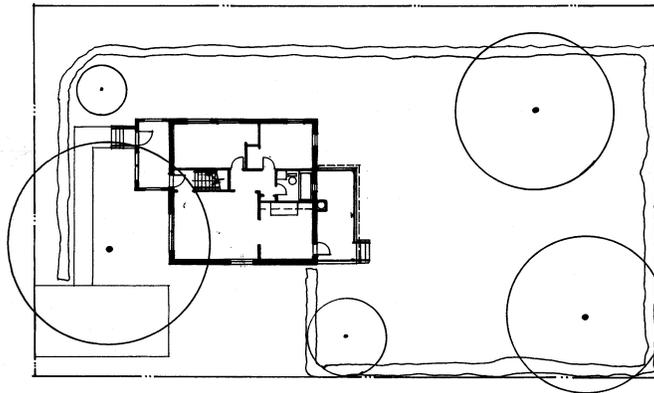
Ajout d'un pavillon-jardin (Friedman, 2002, p. 95).
